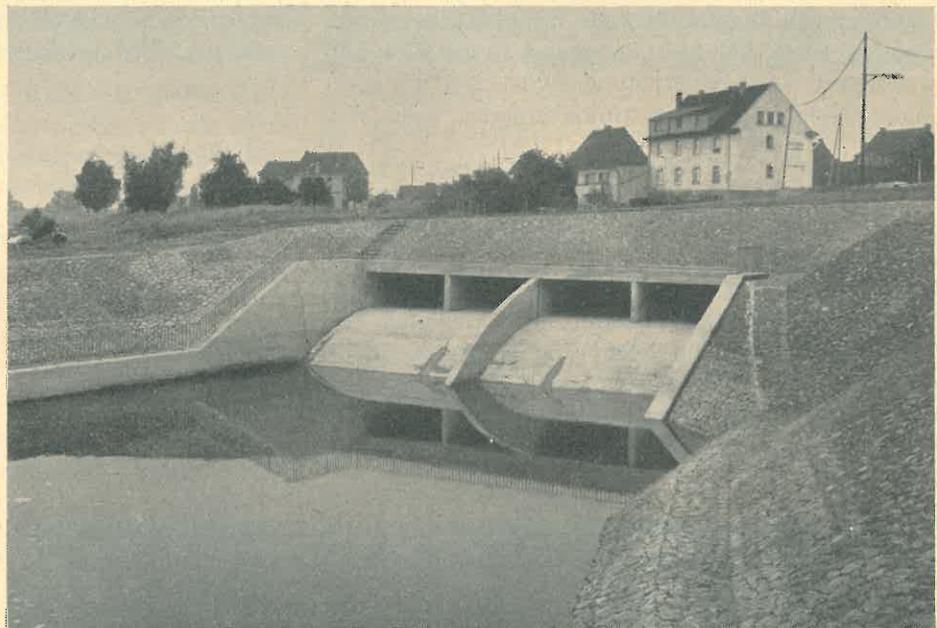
(links oben): Der Randkanal wurde auf seiner ganzen Länge mit ausgekleidetem Profil erstellt. Gegenüber einer Ausführung als Erdkanal ergeben sich Einsparungen an Profil, Grunderwerb und Brückenbauten. - Der im Bild gezeigte Kanalabschnitt ist mit einer Betonauskleidung versehen / Bild 19 (rechts oben): Eine andere Art der Auskleidung ist der Asphaltbeton, der auf dem sandigen Untergrund des Randkanal-Unterlaufes zur Anwendung gekommen ist.
